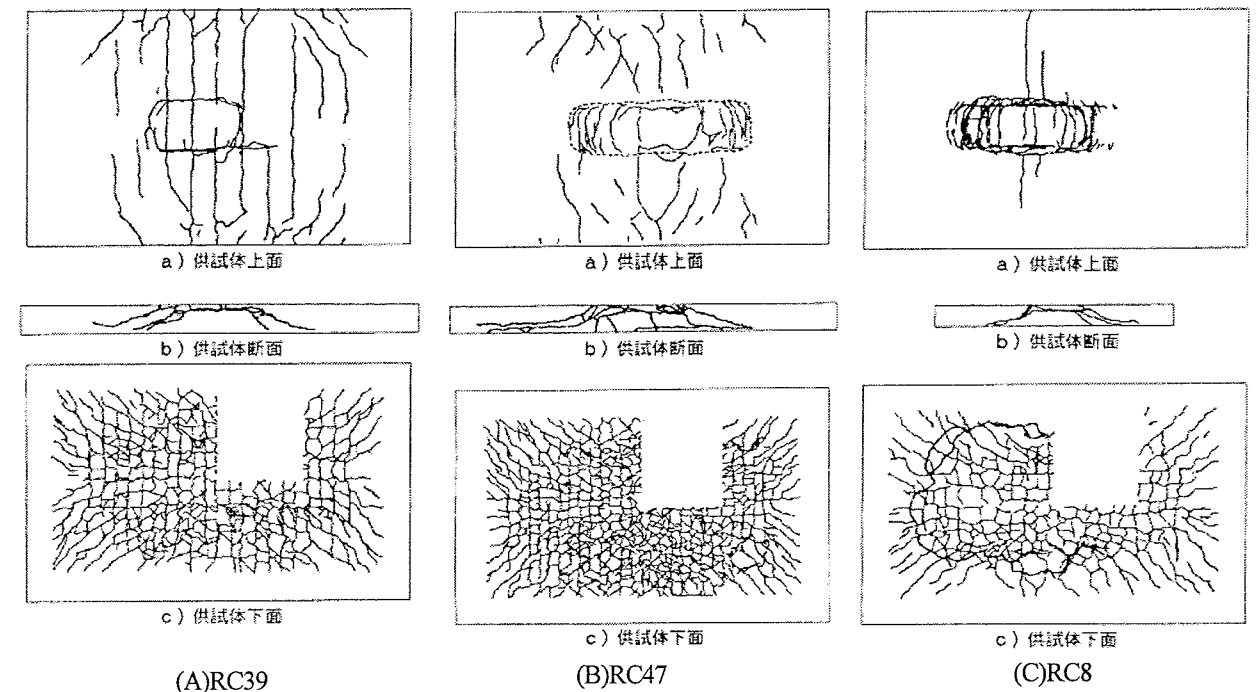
床版ひび割れ状況(RC39, RC47, RC8)
